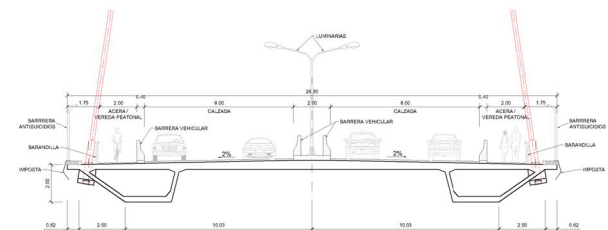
Sección transversal tipo del vano central. Fuente: TYPESA.
